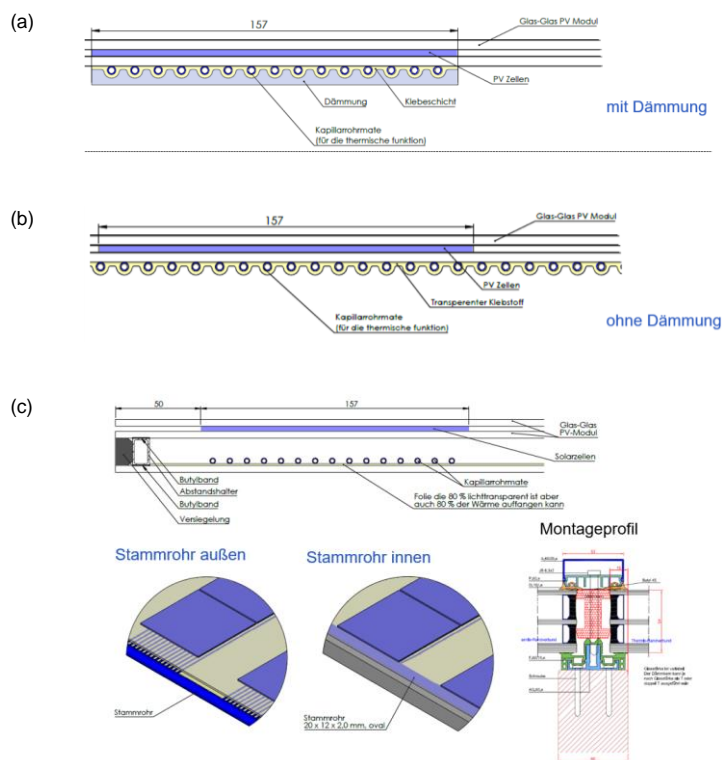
Konstruktionsvarianten mit Kapillarrohrmatte: (a) direkt mit Dämmung, (b) direkt ohne Dämmung und (c) mit Luftspalt und zwei Möglichkeiten zur Stammrohrführung sowie mögliches Montageprofil
